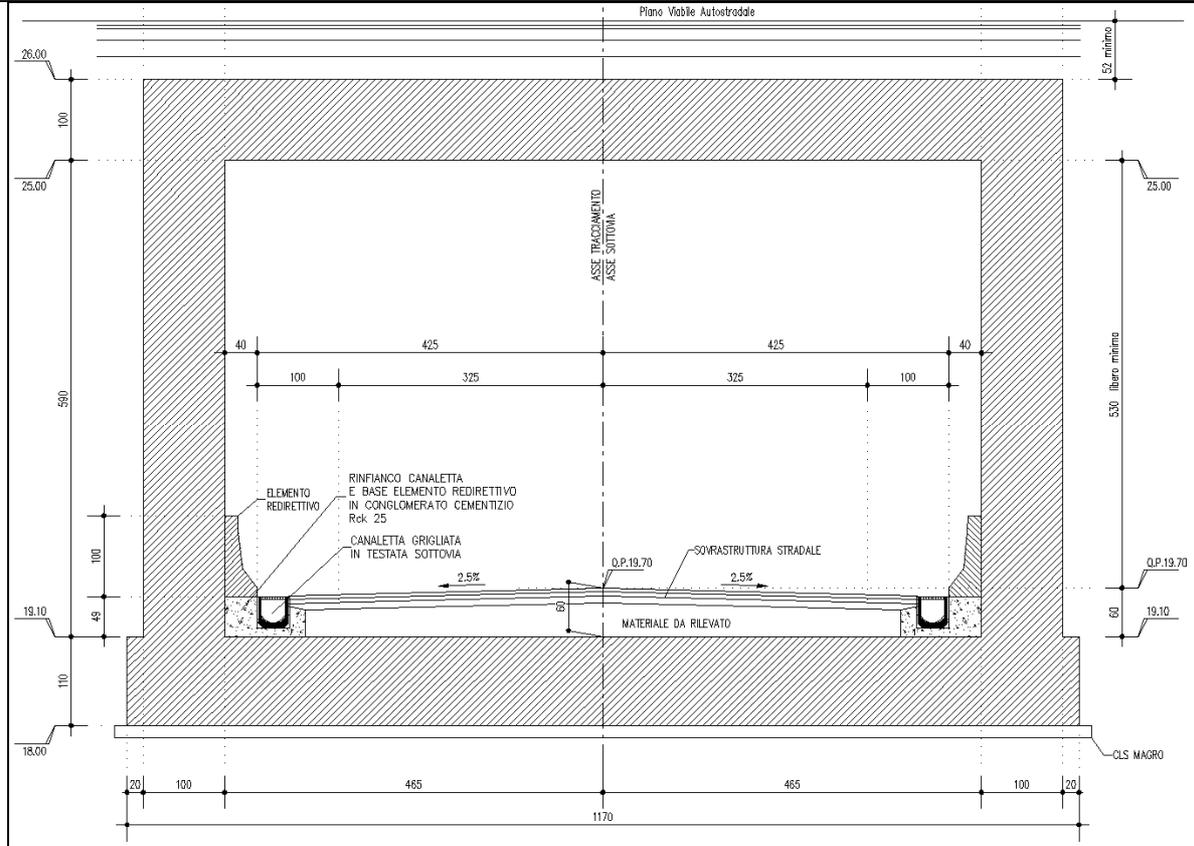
SEZIONE TRASVERSALE DEL SOTTOVIA
